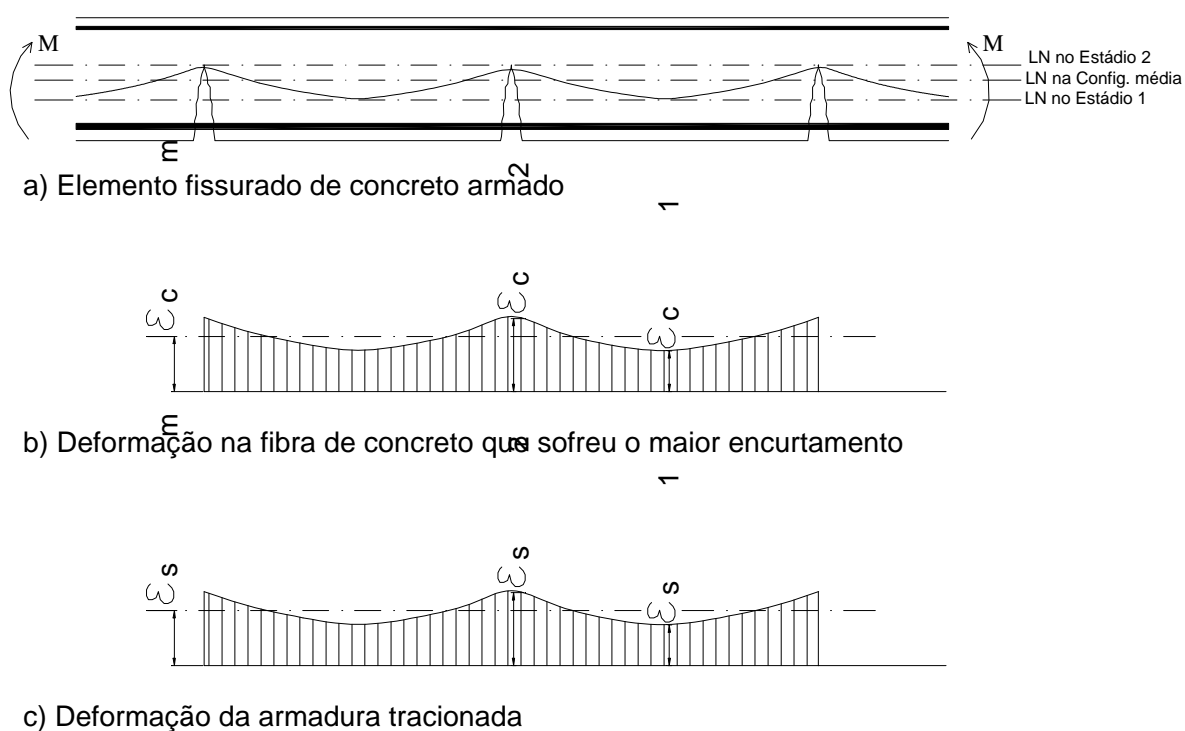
Contribuição do concreto intacto entre fissuras – “tension stiffening” – na flexão simples.
